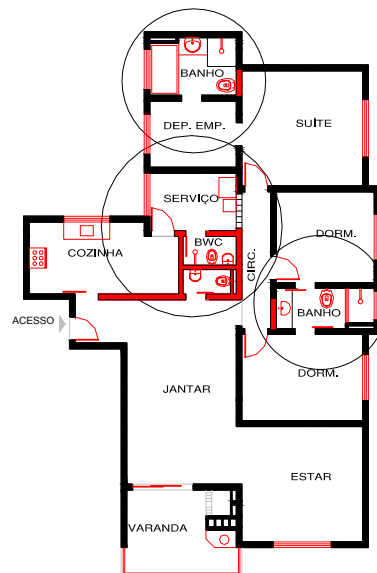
Planta Baixa do apartamento 603 – Estudo de caso A.
